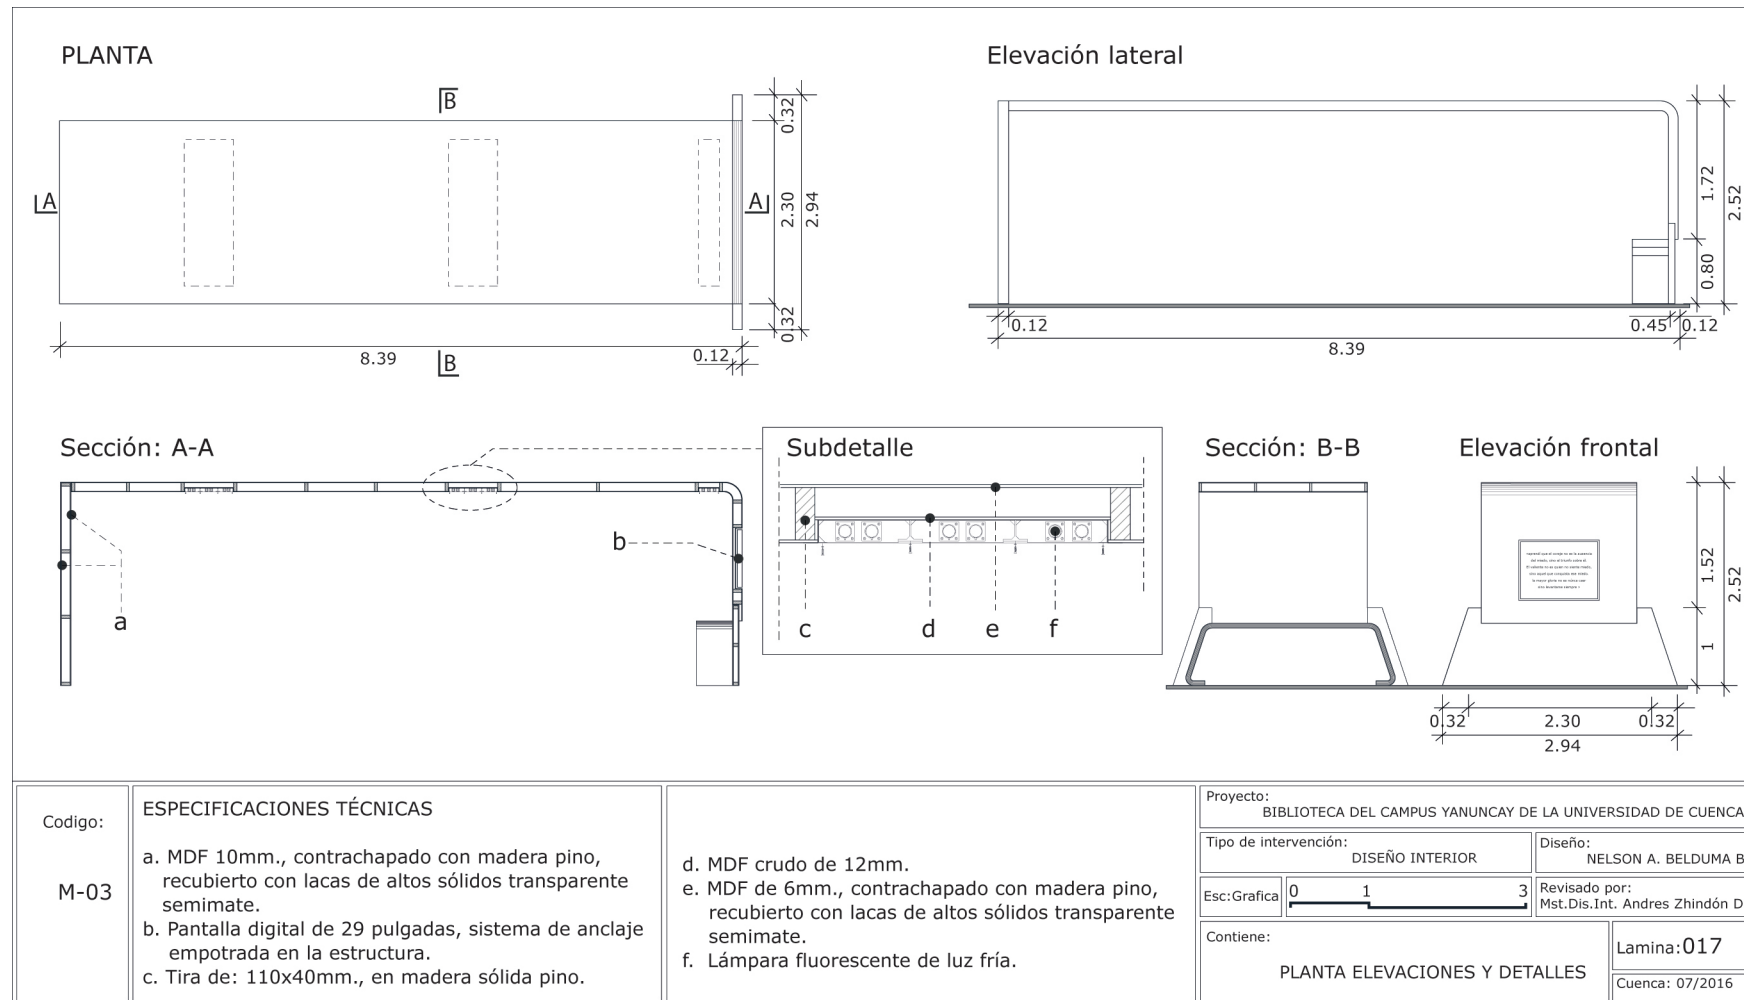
Planta, elevaciones y detalles. Sala de lectura. M-03.
